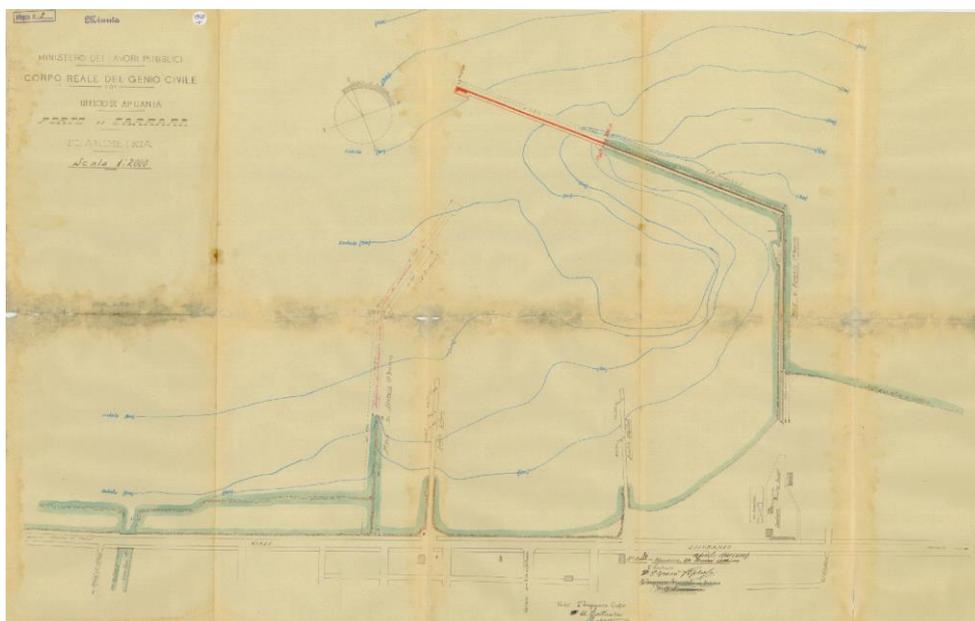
Planimetria di progetto delle opere foranee del 1940 (fonte: Archivio OO.MM.)
